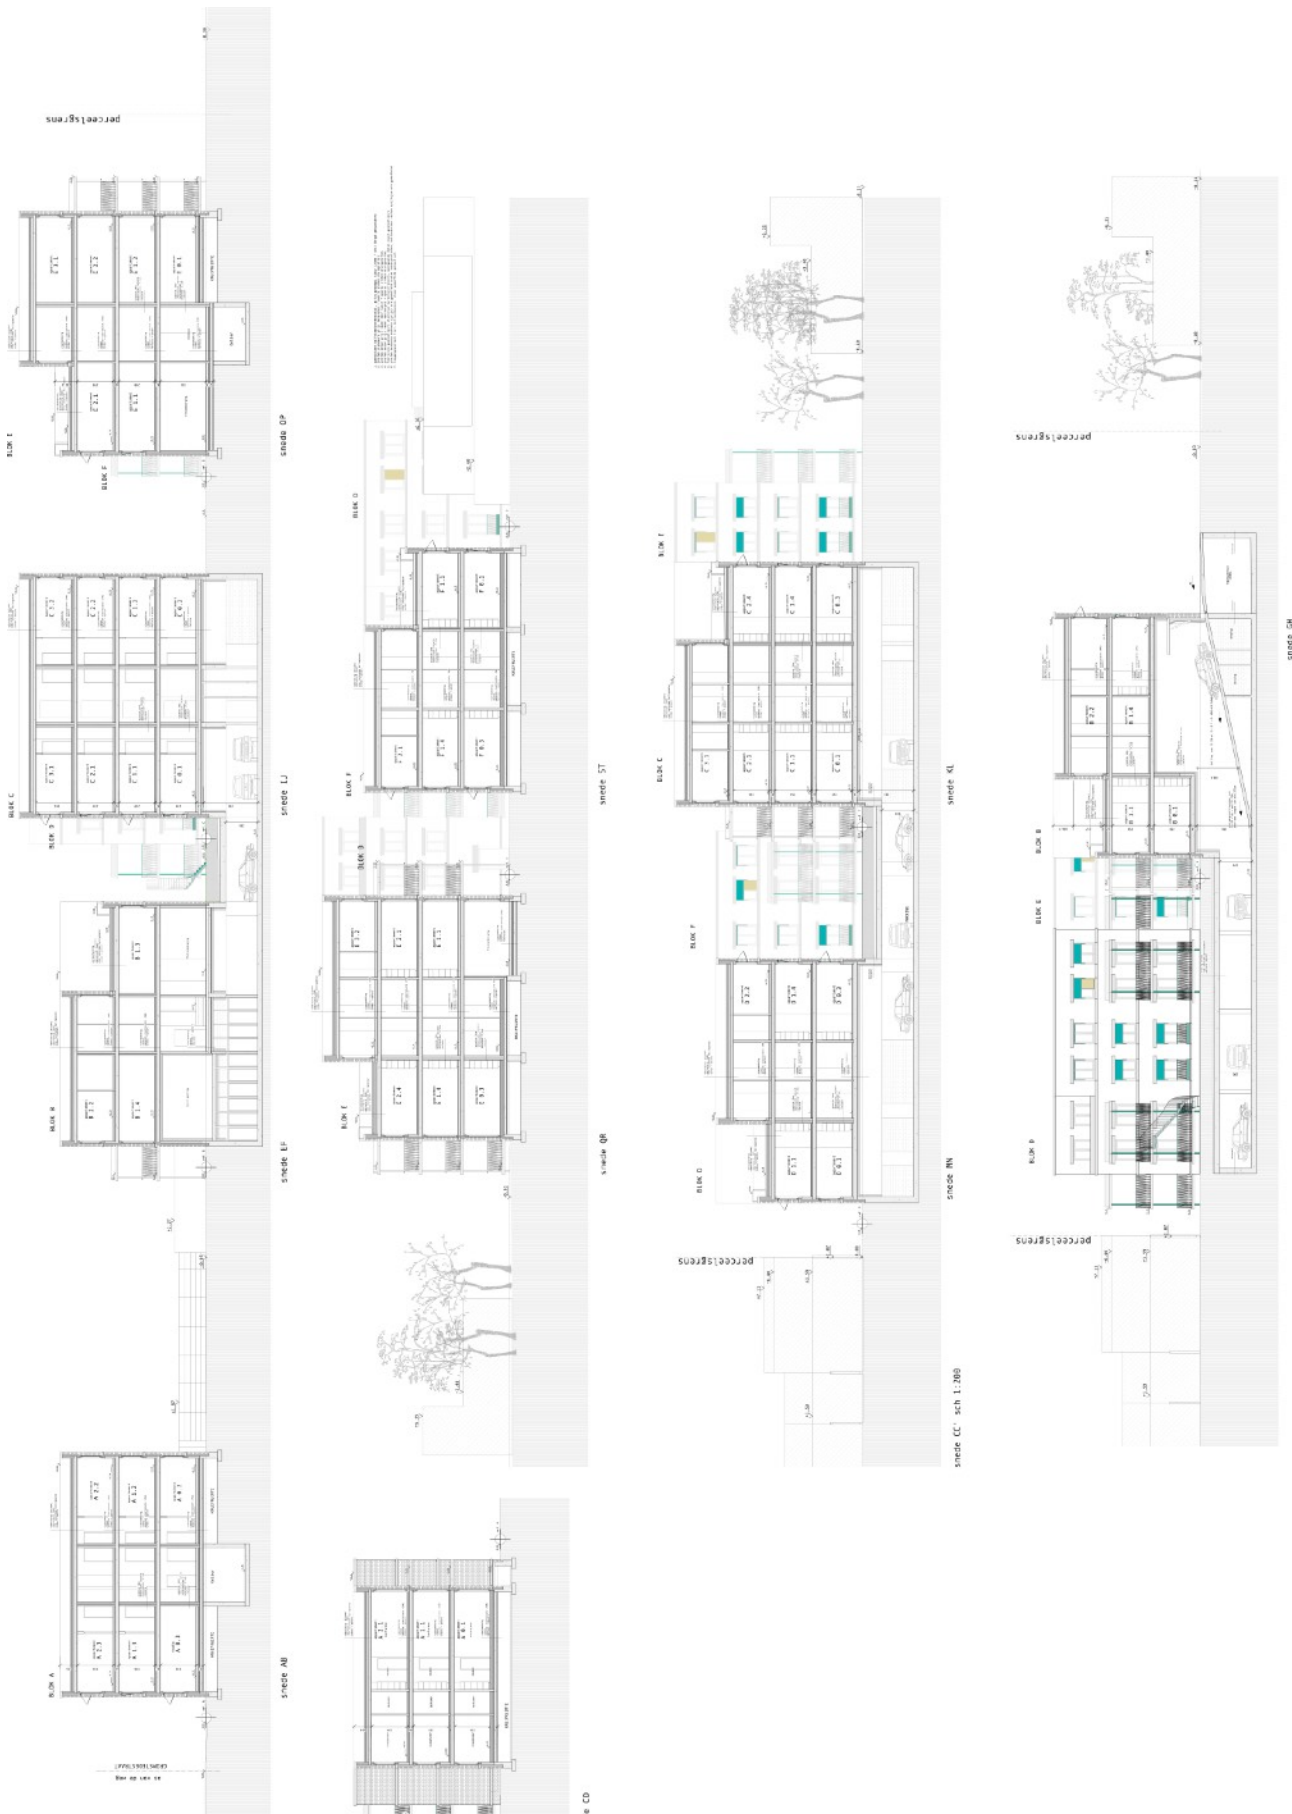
PLAN 18. Doorsneden door het ontwerp © Puls architecten
